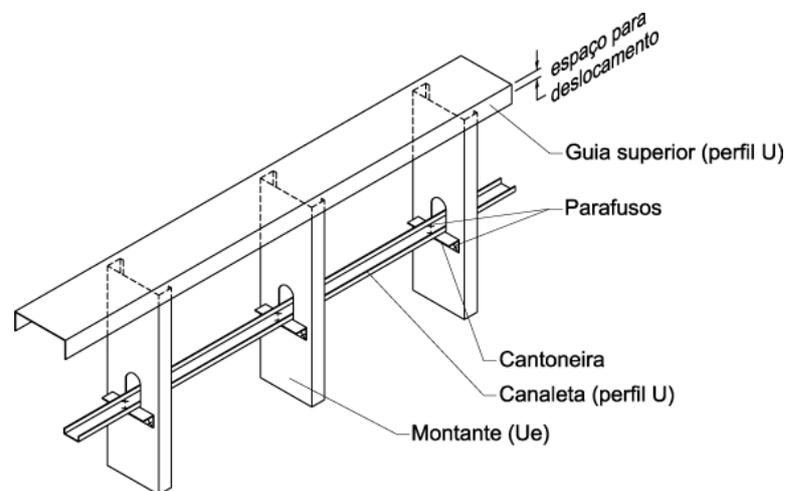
Travamento superior com canaleta e cantoneiras
